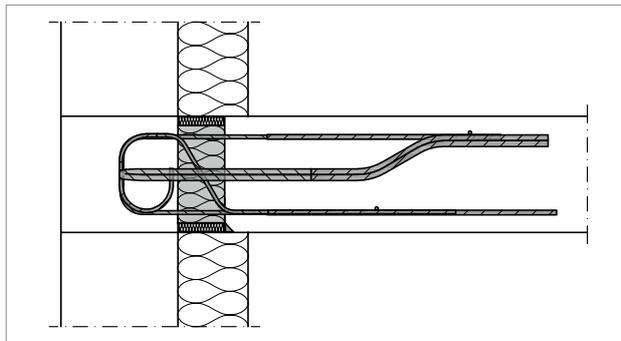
Schöck Rutherma® T type DFi-S (H 200–250) : liaison pour façade en béton armé et dalle en béton coulé sur place
